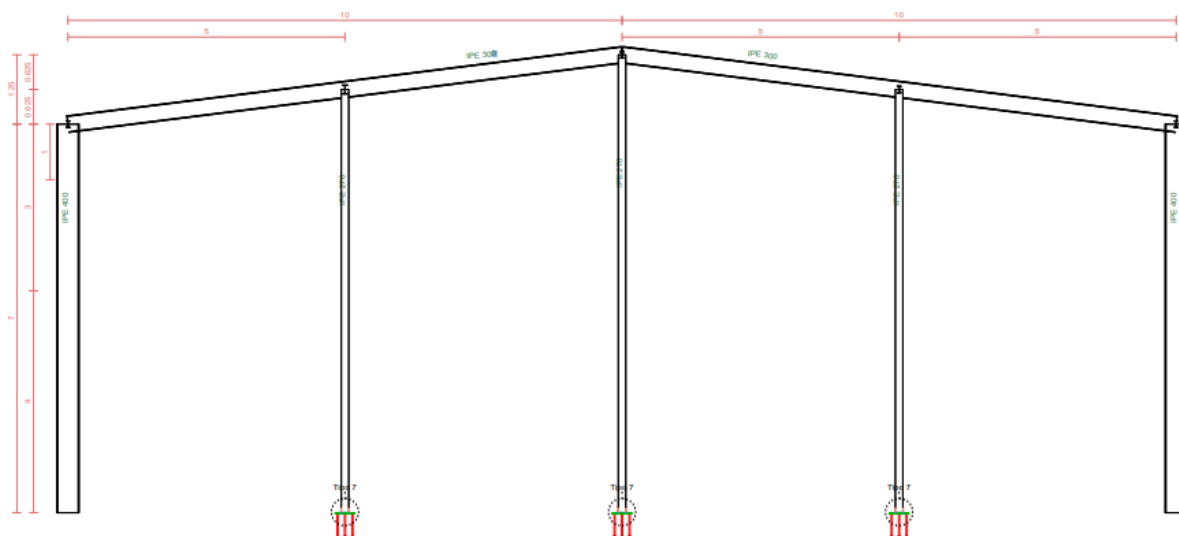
VISTA PÓRTICO LATERAL - AUTOCAD
